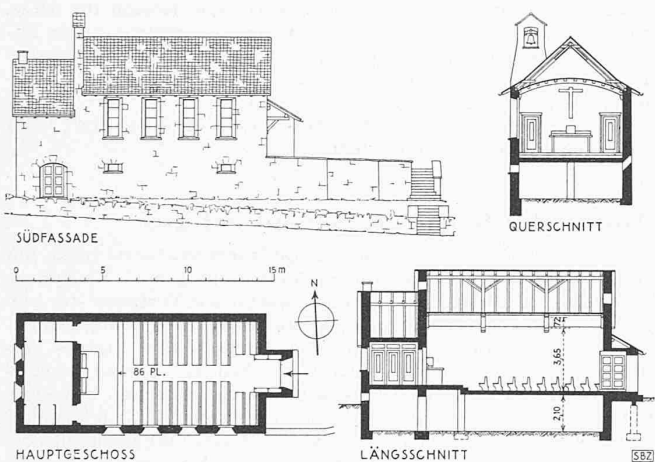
Grundriss, Schnitte und Ansicht. — 1:400
